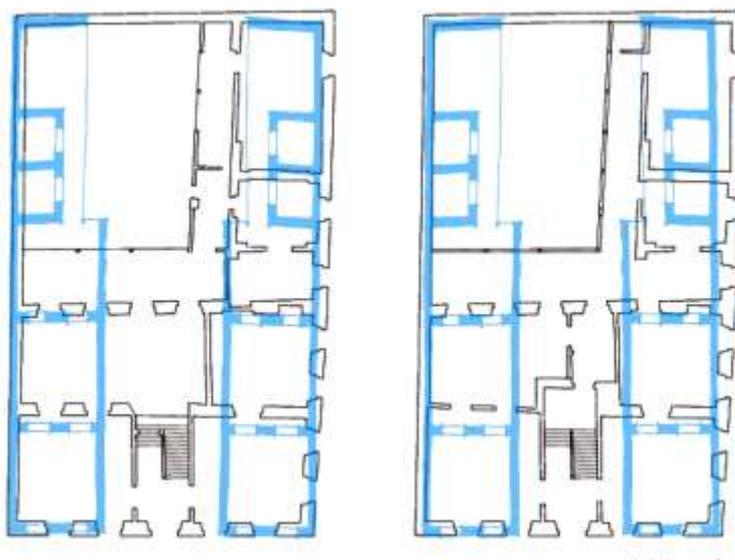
Sobrado H (Pav. Superior e Térreo) sob planta da tipologia genérica porta-e-janela
